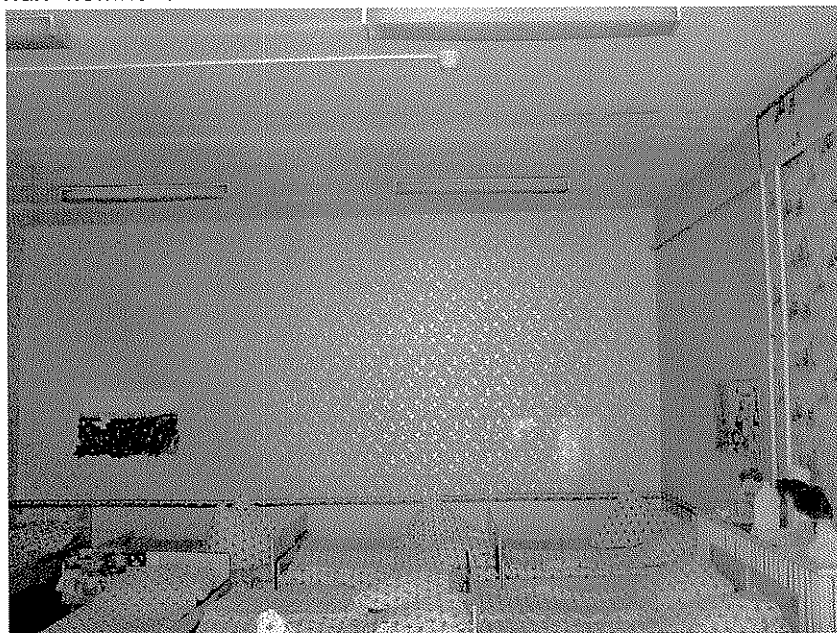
Спальная комната – на перекрытии следы протечек вод атмосферных осадков через повреждения в кровле
